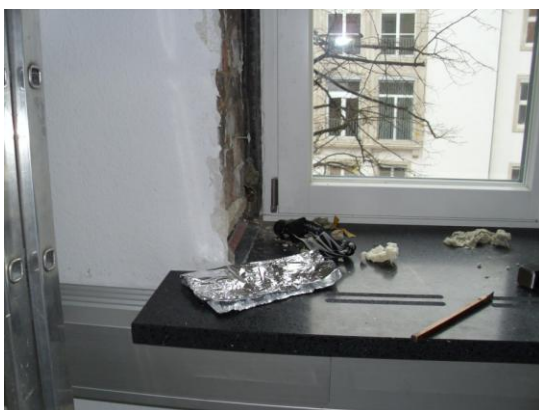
Teeranstrich an Außenschale Mauerwerk
